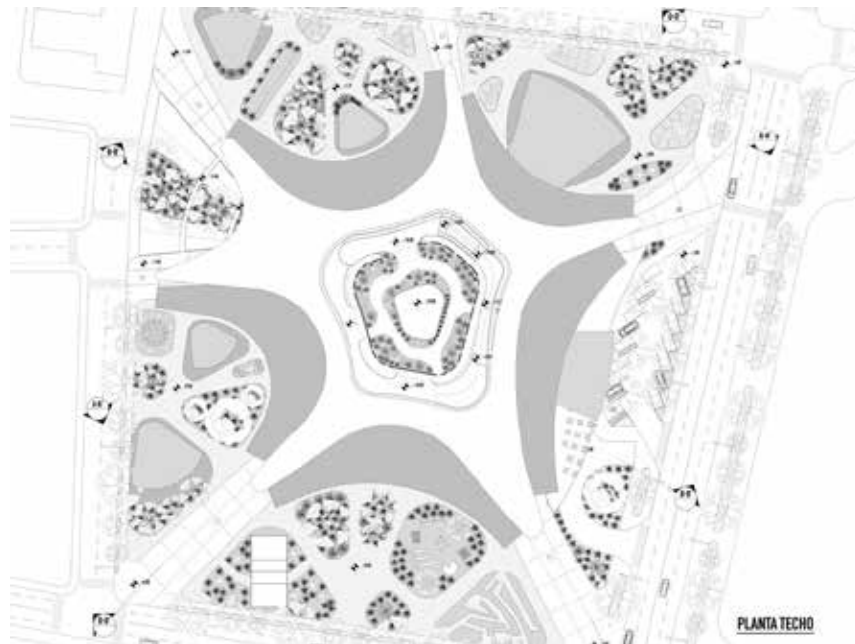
Planta Techo Nivel +16.00. Fuente Propia. 2017.
